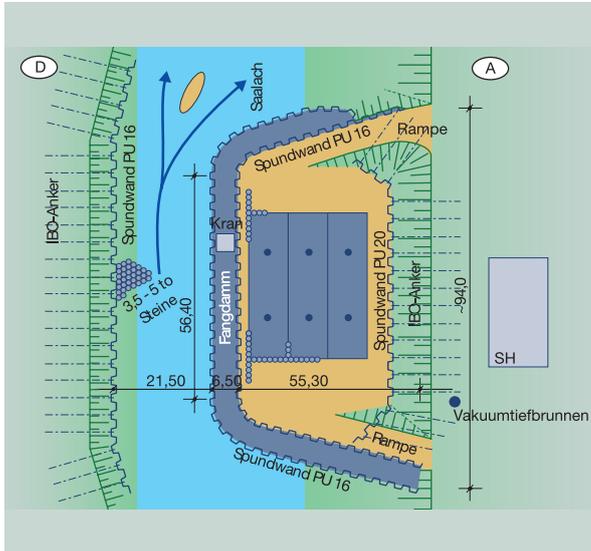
Baugrubenumschließung Bauabschnitt 1
